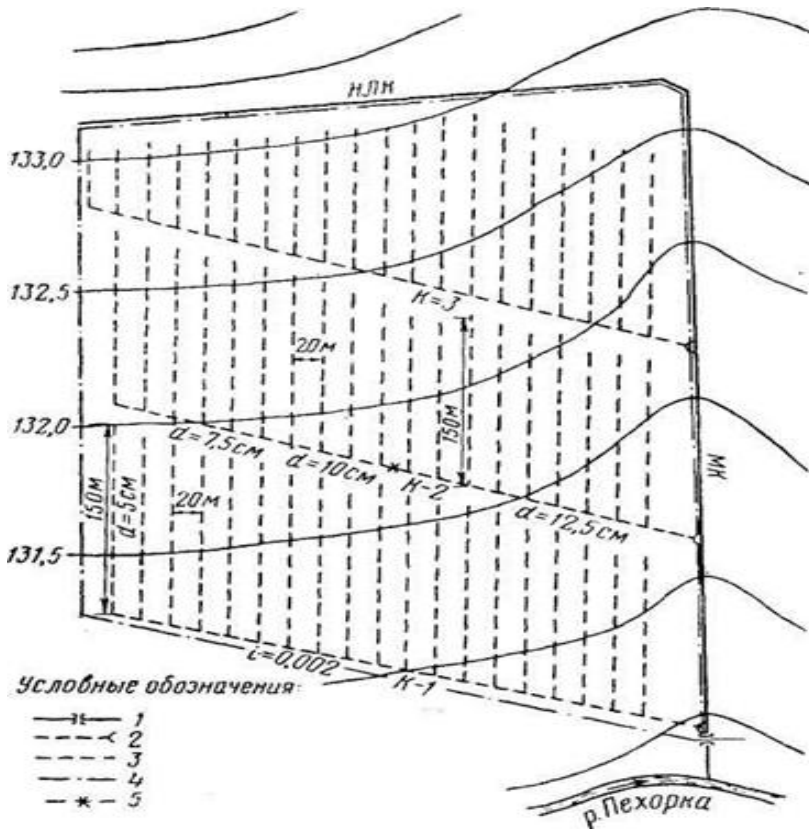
План участка, осушаемого закрытым дренажем (продольная схема):
